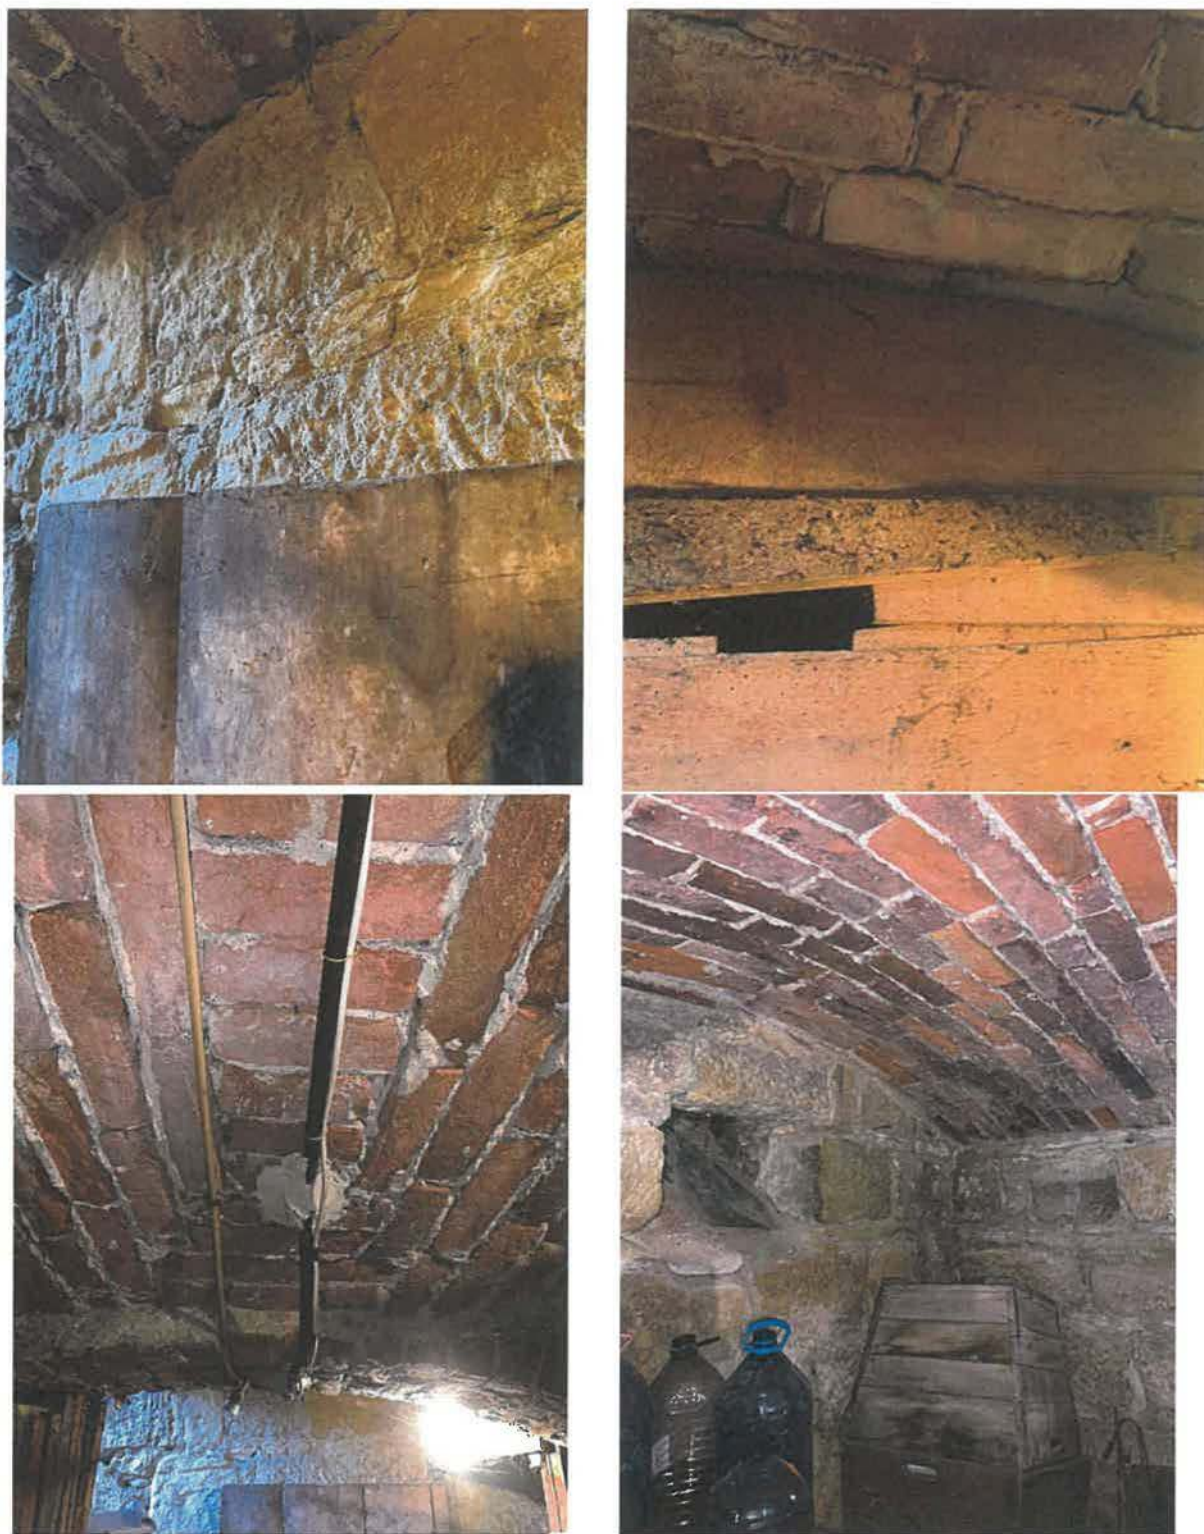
Foto relevante din subsolul construcției str. Avram Iancu nr.66
